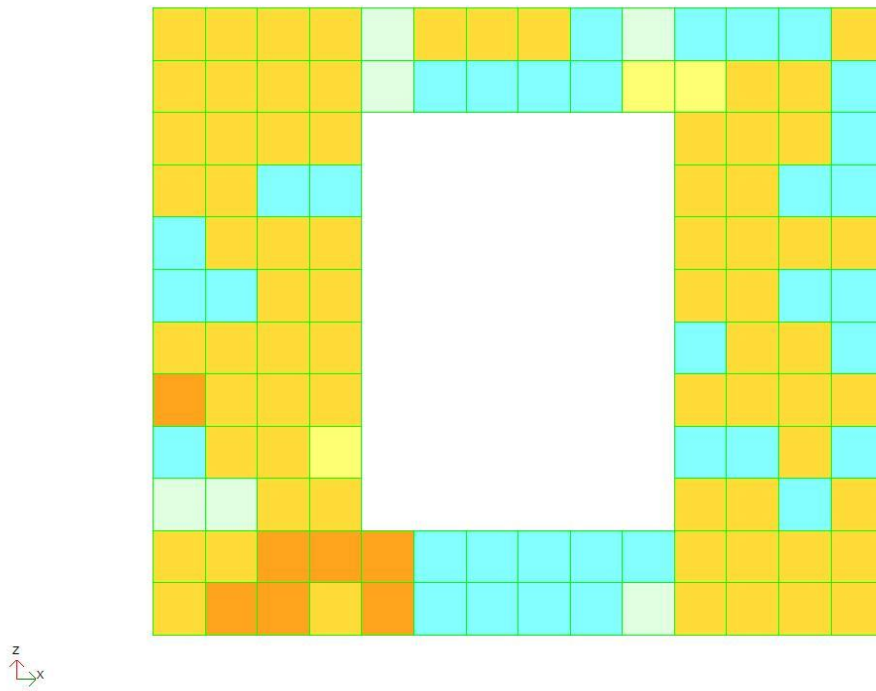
Армування панелі по осі А÷2-3(по Y у нижньої грані)
